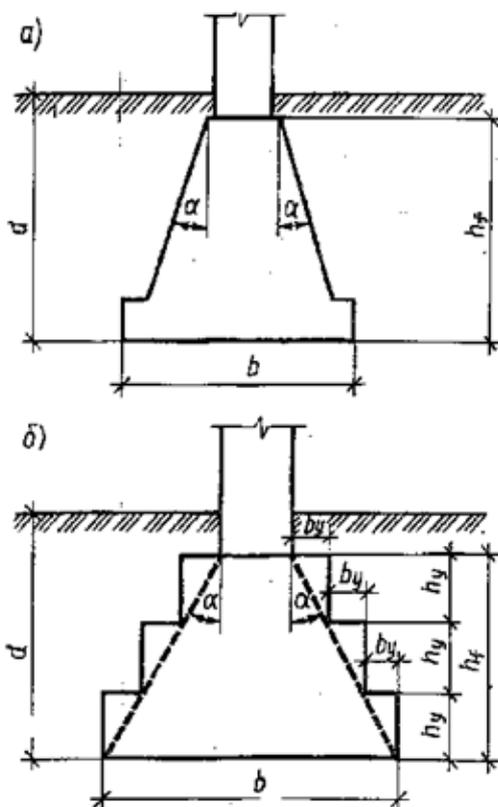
Конструкция жесткого фундамента: а – с наклонными боковыми гранями; б – уширяющийся к подошве уступами
